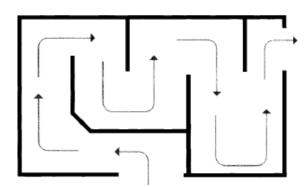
Denah pendekatan alur pengunjung dalam pameran (alur yang tidak berstruktur).
